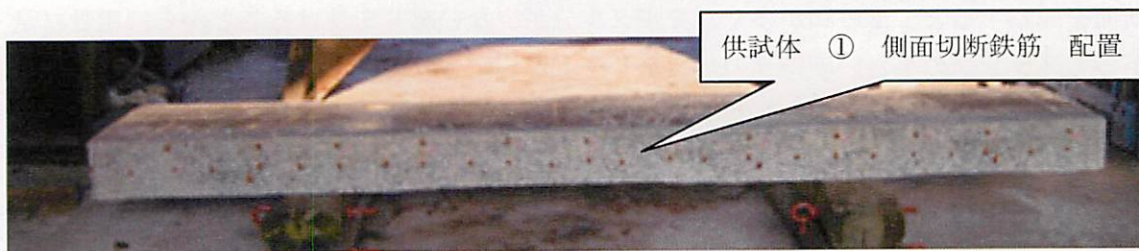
供試体側面 切断面の鉄筋位置確認
